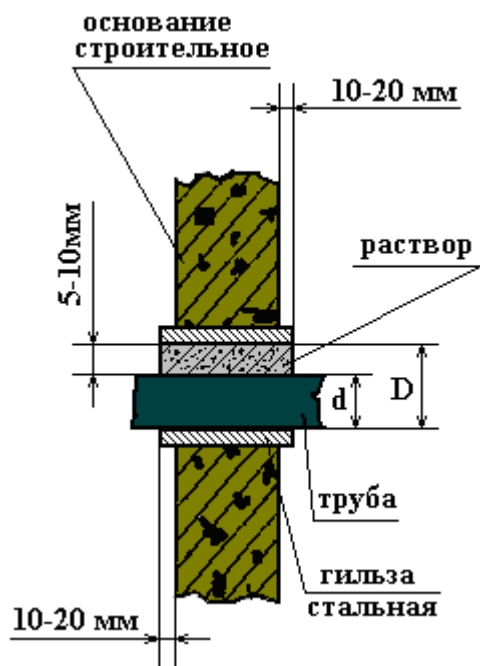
Переход стальной трубы через вертикальное строительное основание
